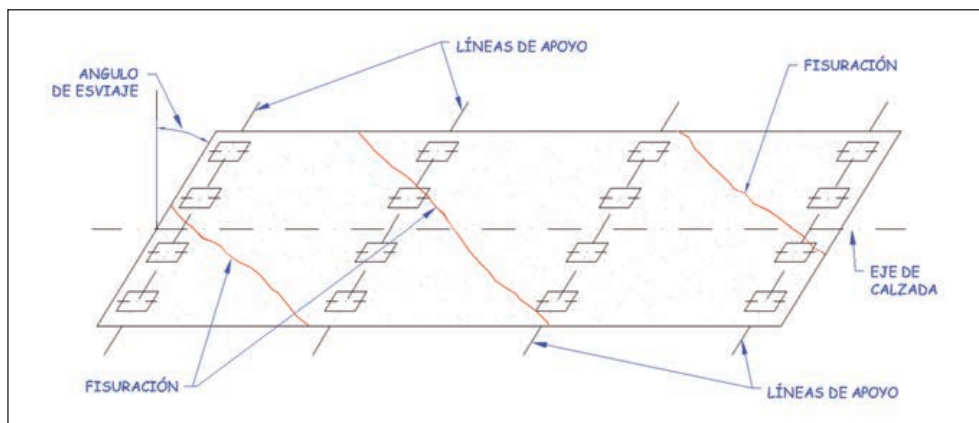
ESQUEMA DE FISURACIÓN DE LOS PUENTES ESVIADOS.
